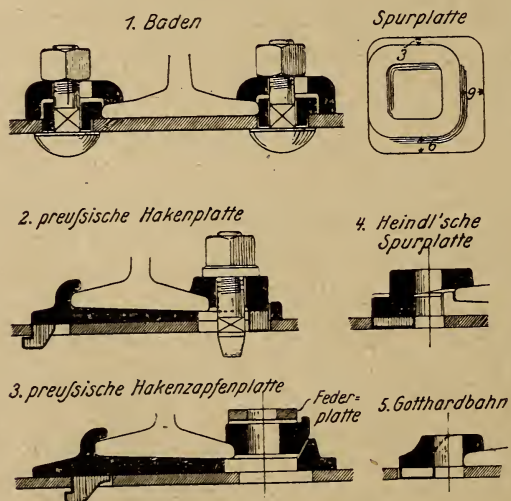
Befestigung eiserner Schwellen 1 : 6.
